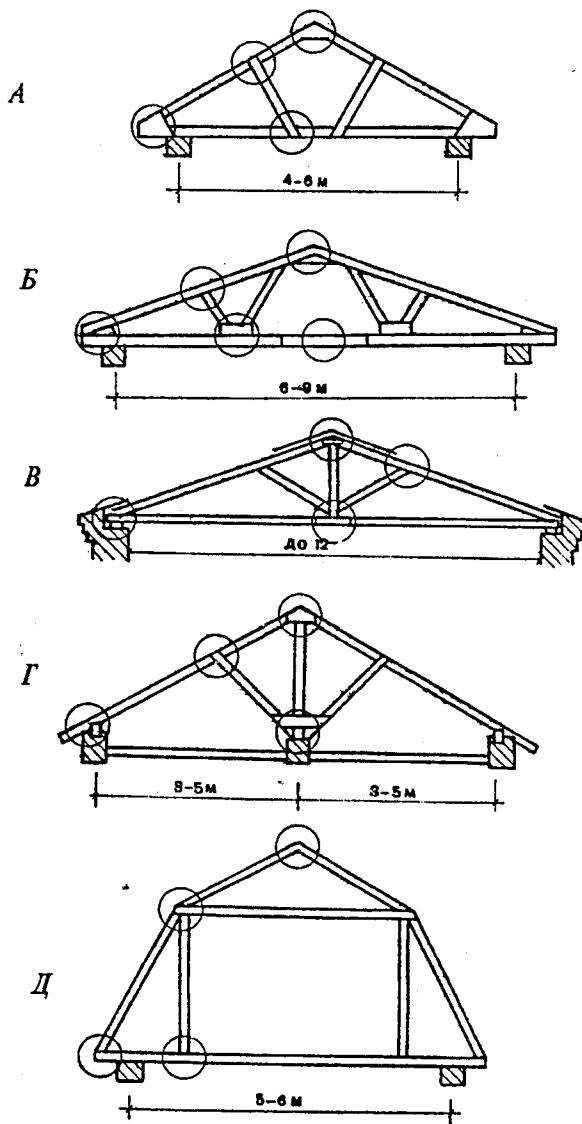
Крокв'яні ферми: А – висяча ферма однопрогінного будинку; Б – ферма з підкосами; В – ферма для однопрогінного будинку більше 8 м; Г – похила крокв'яна ферма; Д – ферма для мансардного даху.
